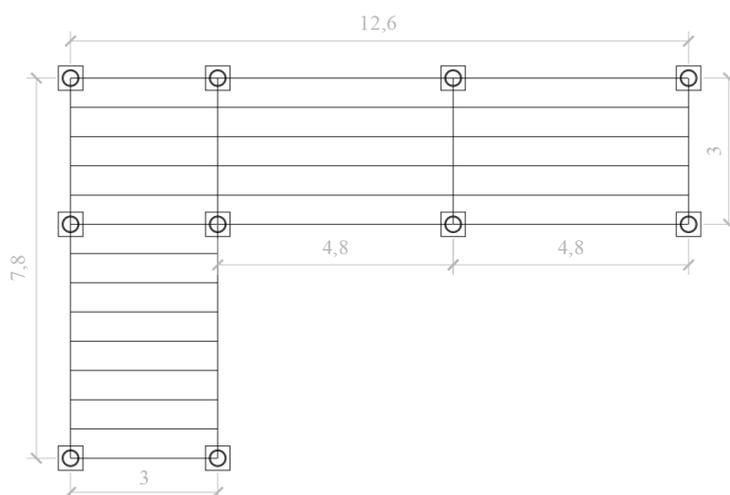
Planta baixa do pergolado com dimensões em metros. Fonte: Elaborado pelos autores.
